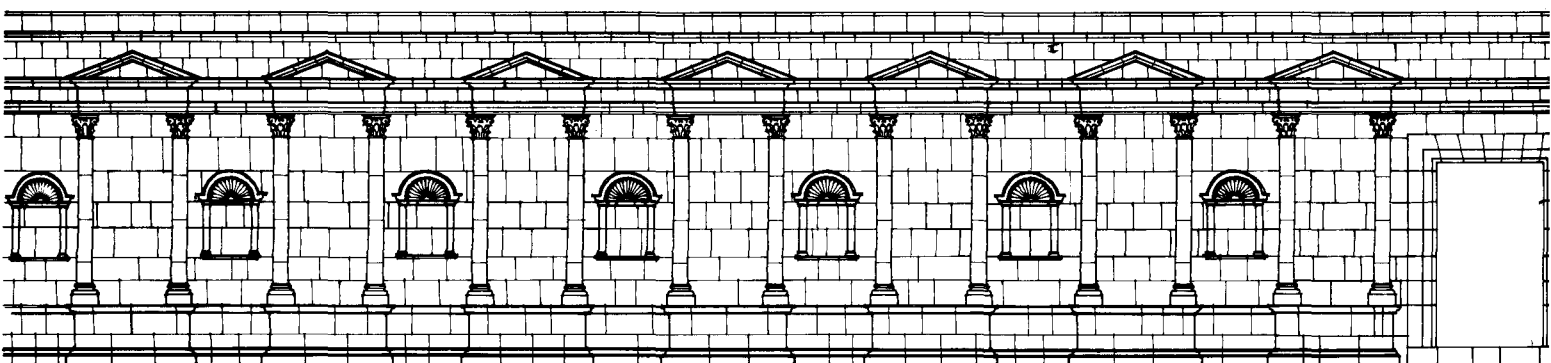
Alzado reconstruido del lado norte del ténenos.
